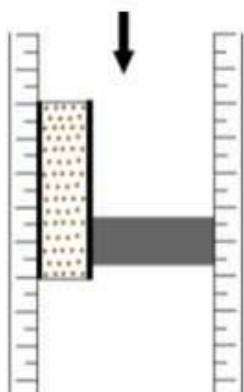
Rampe sur une partie de la largeur d'un ouvrage (ONEMA)
